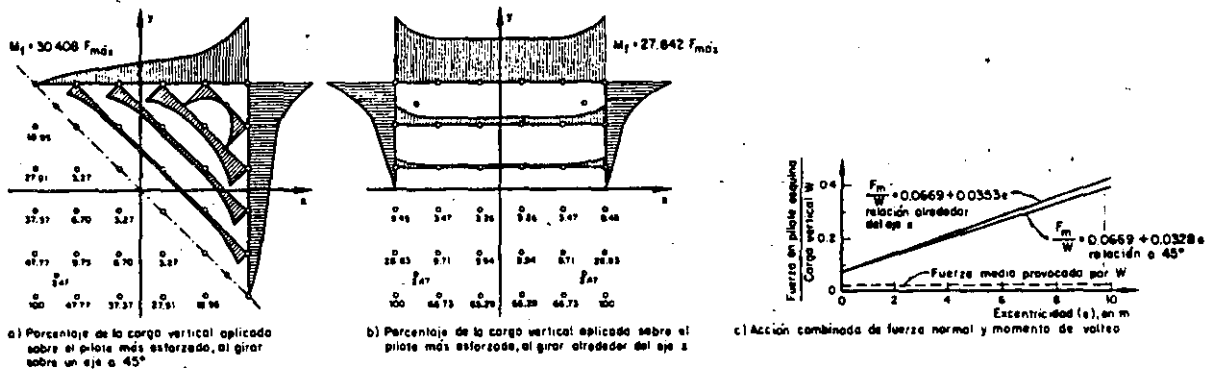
Distribución de cargas en 40 pilotes, provocadas por la acción de momentos flexionantes sobre la cimentación
